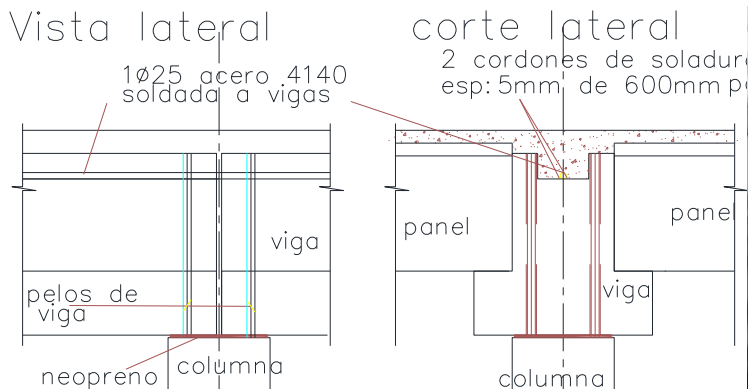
Detalle de la unión viga columna mediante pasadores
